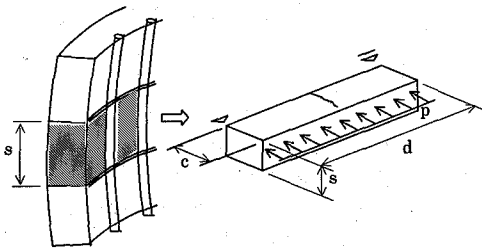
軸方向鉄筋のはらみ出しによる力とかぶりコンクリートのモデル化
